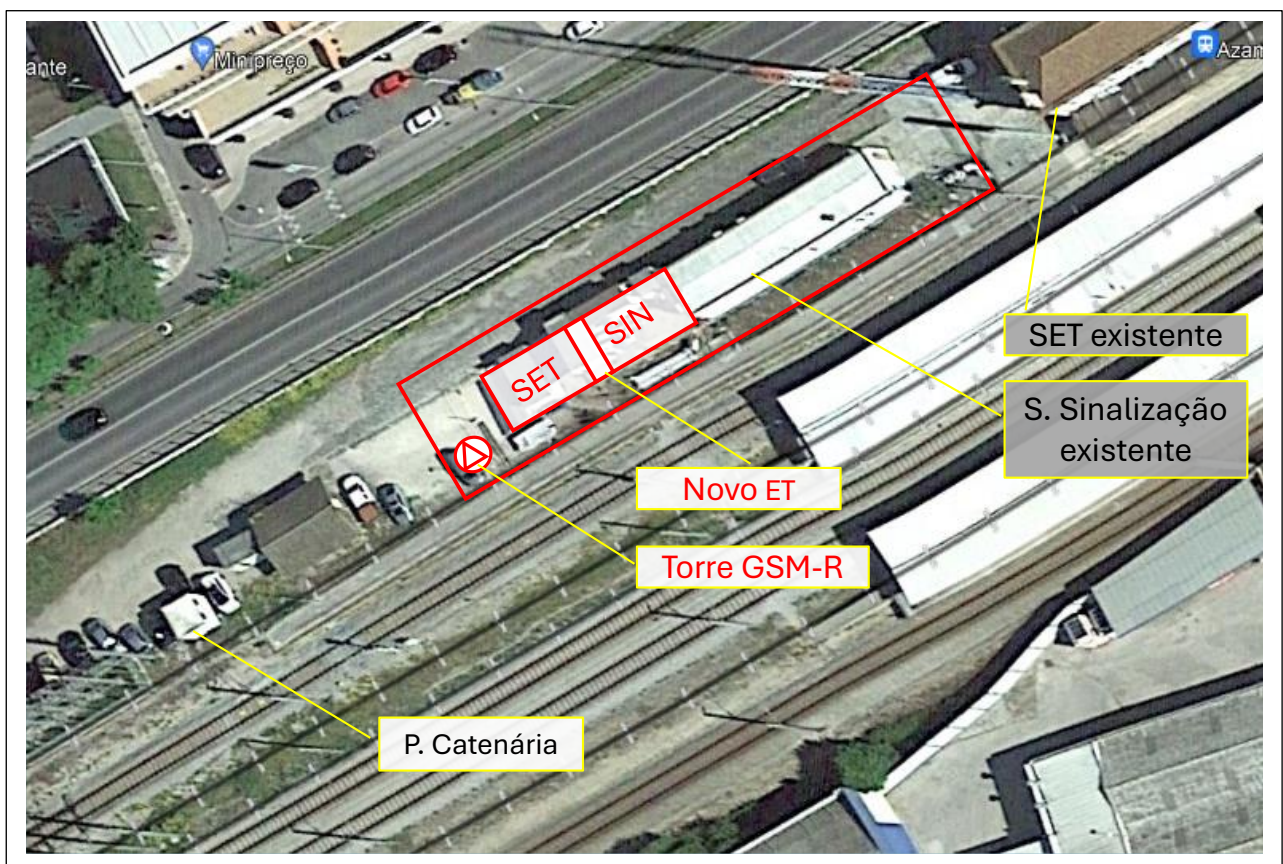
Estação GSM-R da Azambuja – Localização
